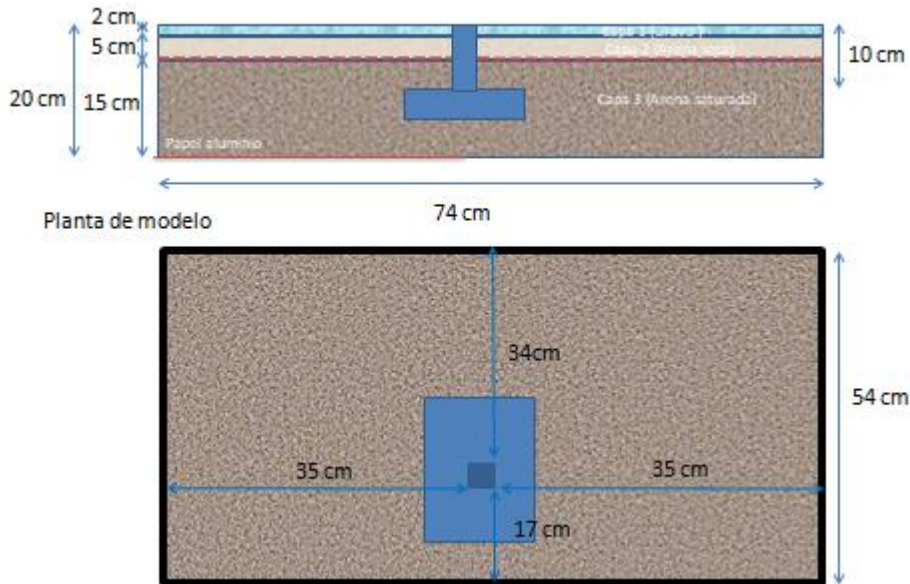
13: Ensayo con elementos de cimentación a escala. Alzado y Planta de la zapata a escala y de su posición relativa respecto a los límites de la cubeta.
